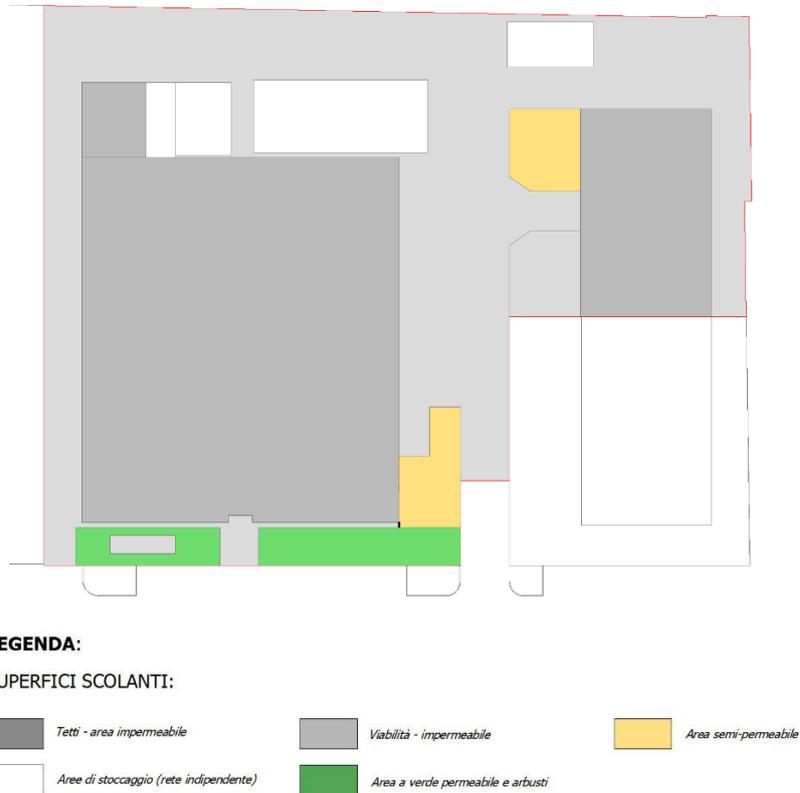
Planimetria stato di progetto – Individuazione aree a diverso uso e scolo
